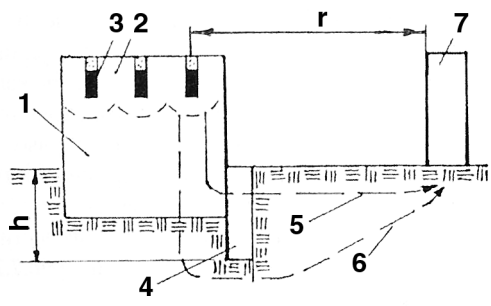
Установка сплошного щитового укрытия на фундаменте:
